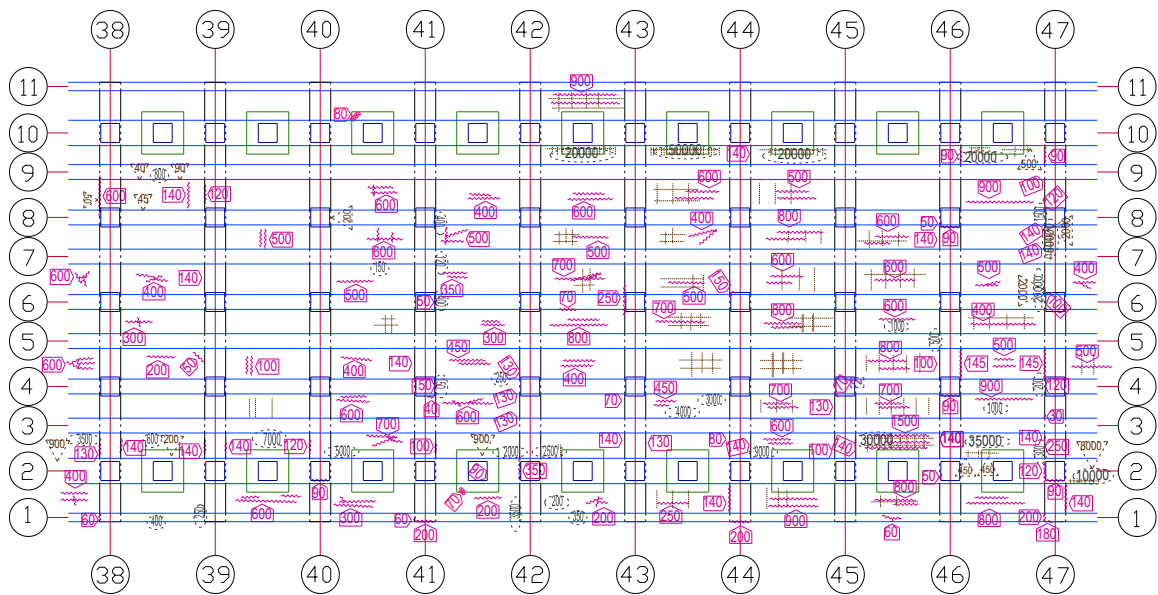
Inspección de daños de vigas 38 y 47 del suelo del muelle. La sección “saludable” comprendió el área del muelle entre las vigas del suelo 38 y 40. La sección “dañada” fue definida como el área del muelle entre las vigas 45 y 47 del suelo.
